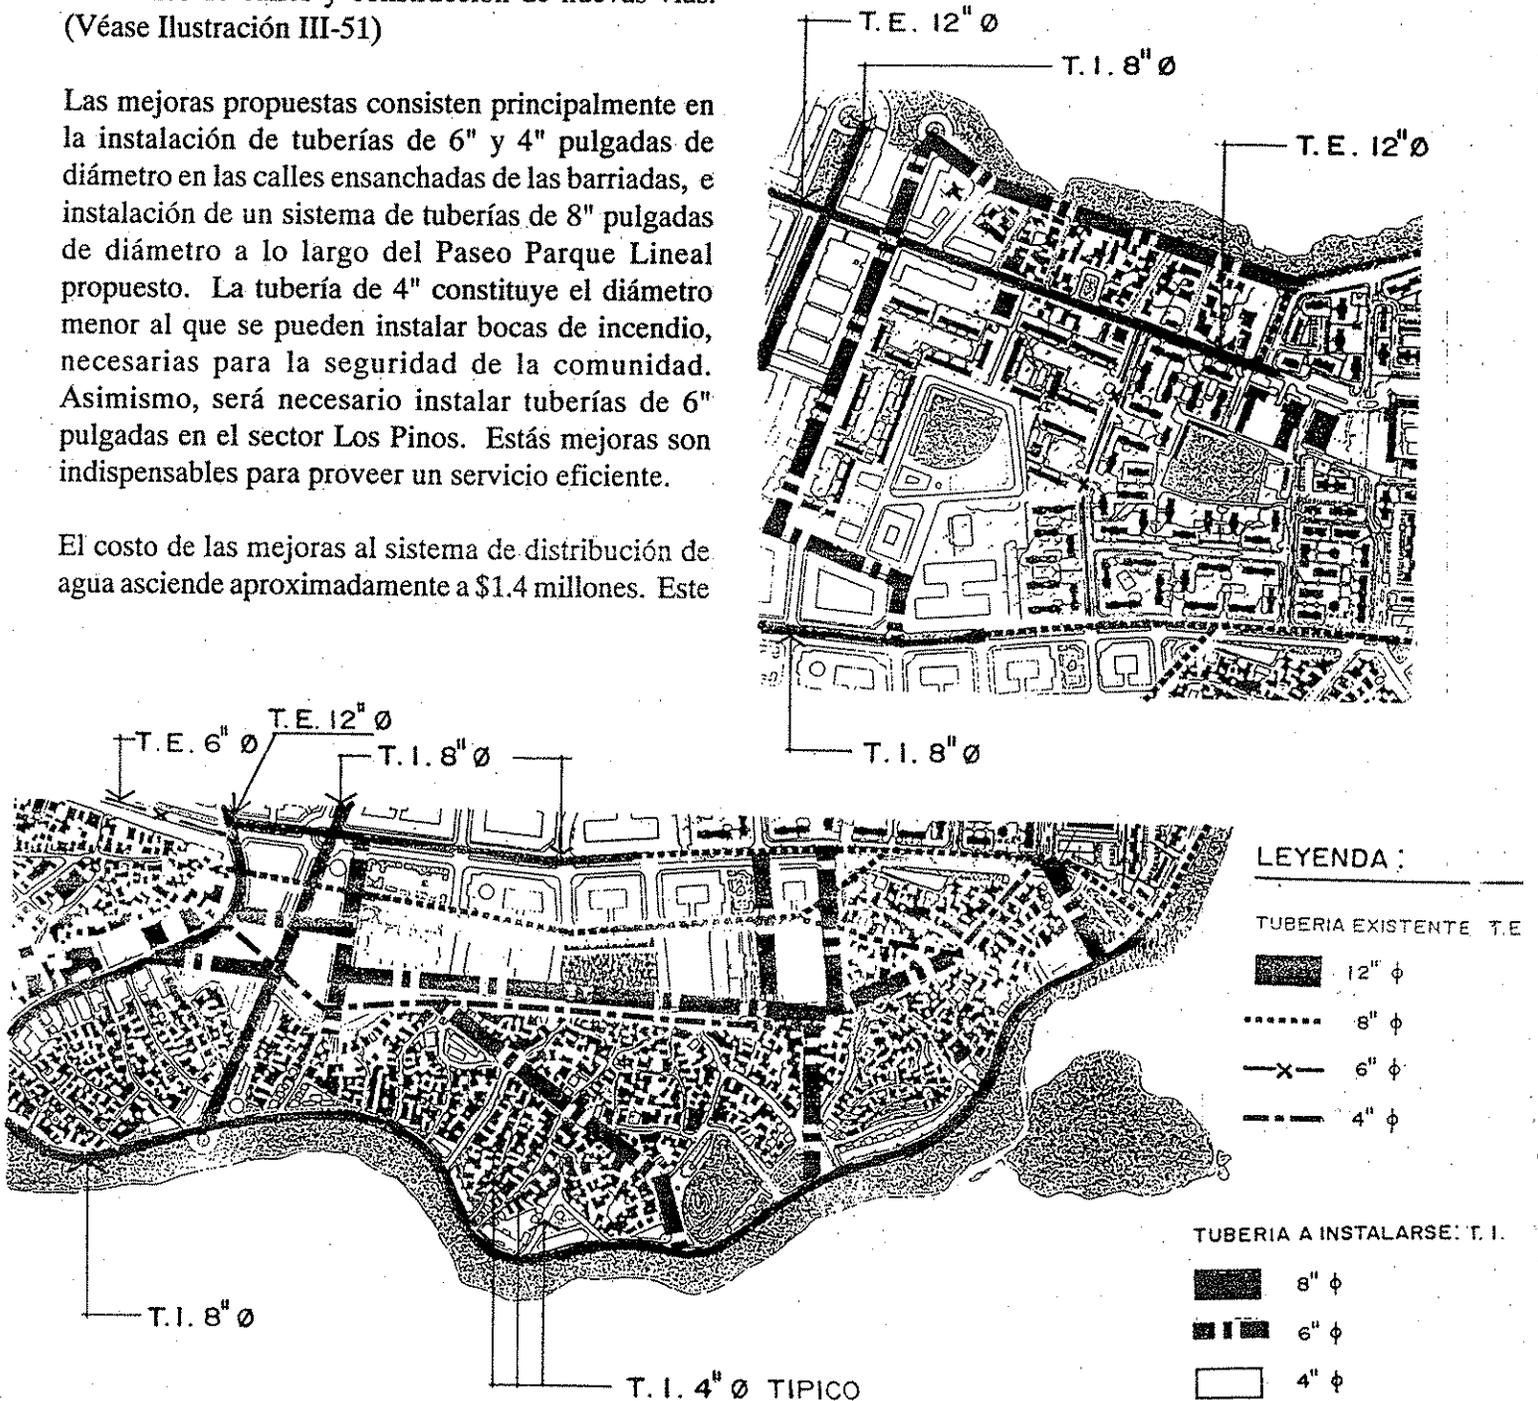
Sistema de Agua Potable Propuesto en Barriadas
